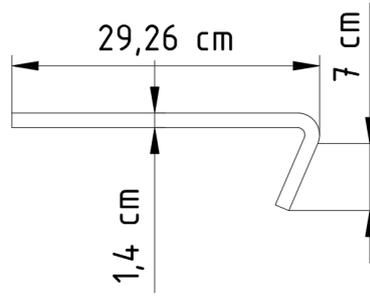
Dimensiones del anclaje del pilar a la zapata.
